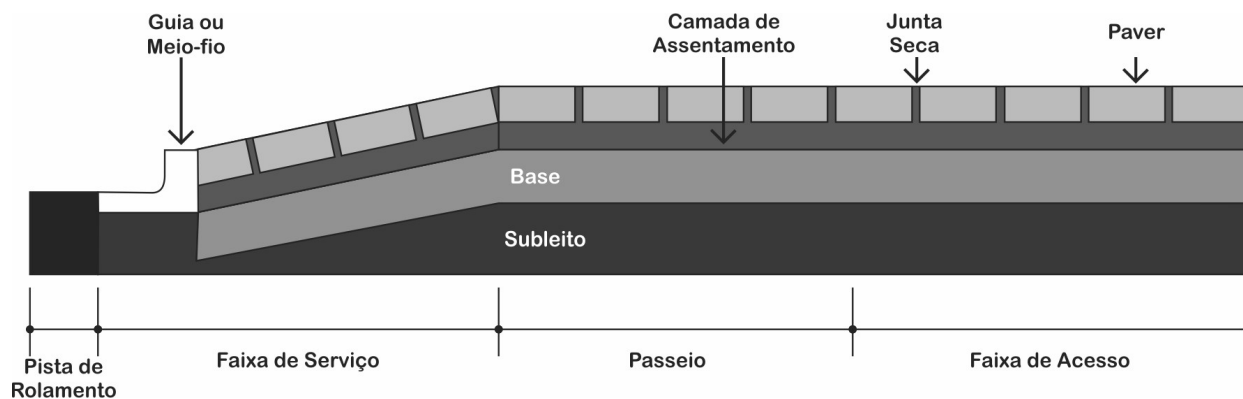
Detalhe do Assentamento do Pavimento Intertravado de concreto nas guias rebaixadas:
